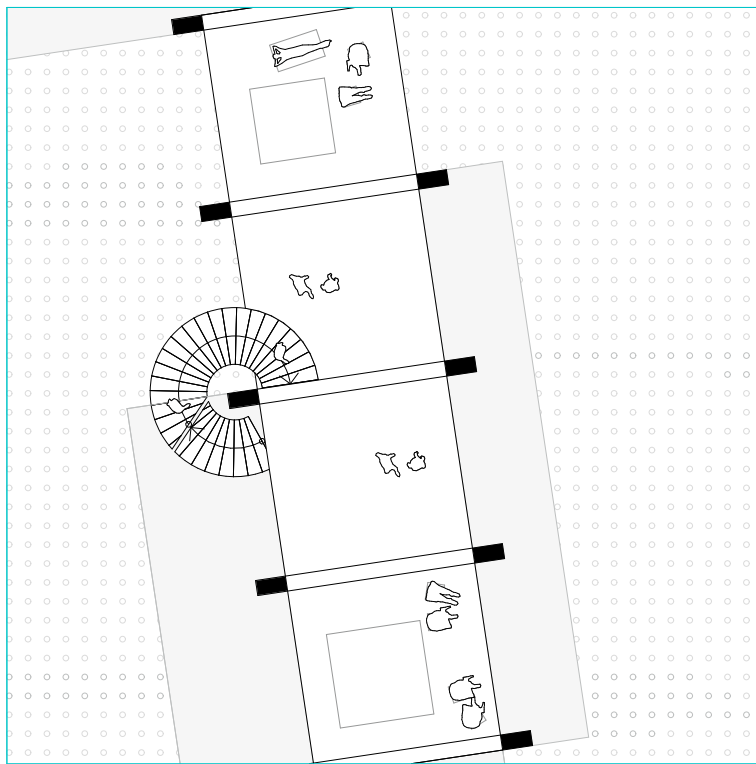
Ausschnitt Grundriss 4. Ebene 1:200
